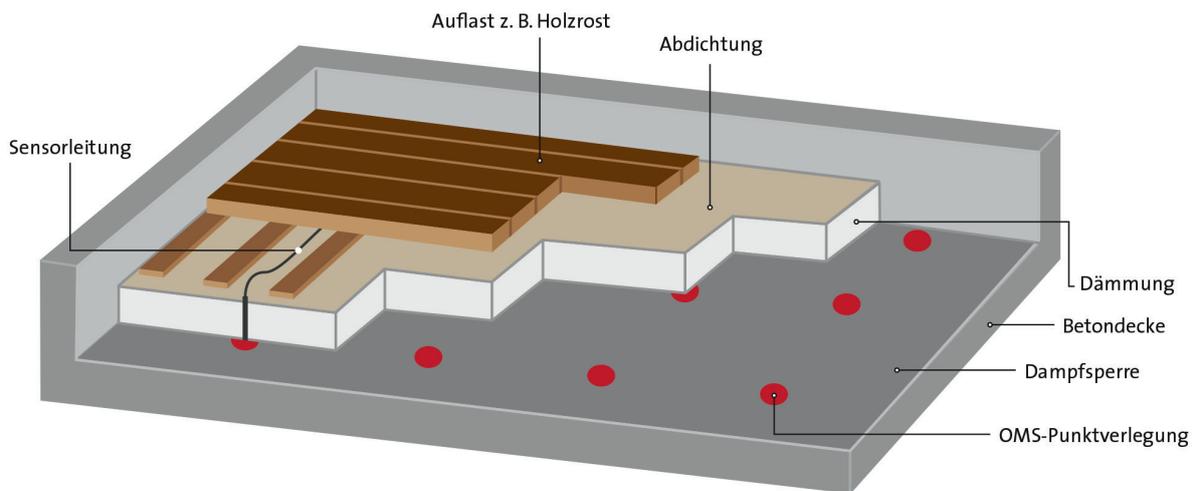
Schema Fixeinbau Punktsensor (Anschlusskabel wird über Kabelausführung durch die Dachhaut geführt)
